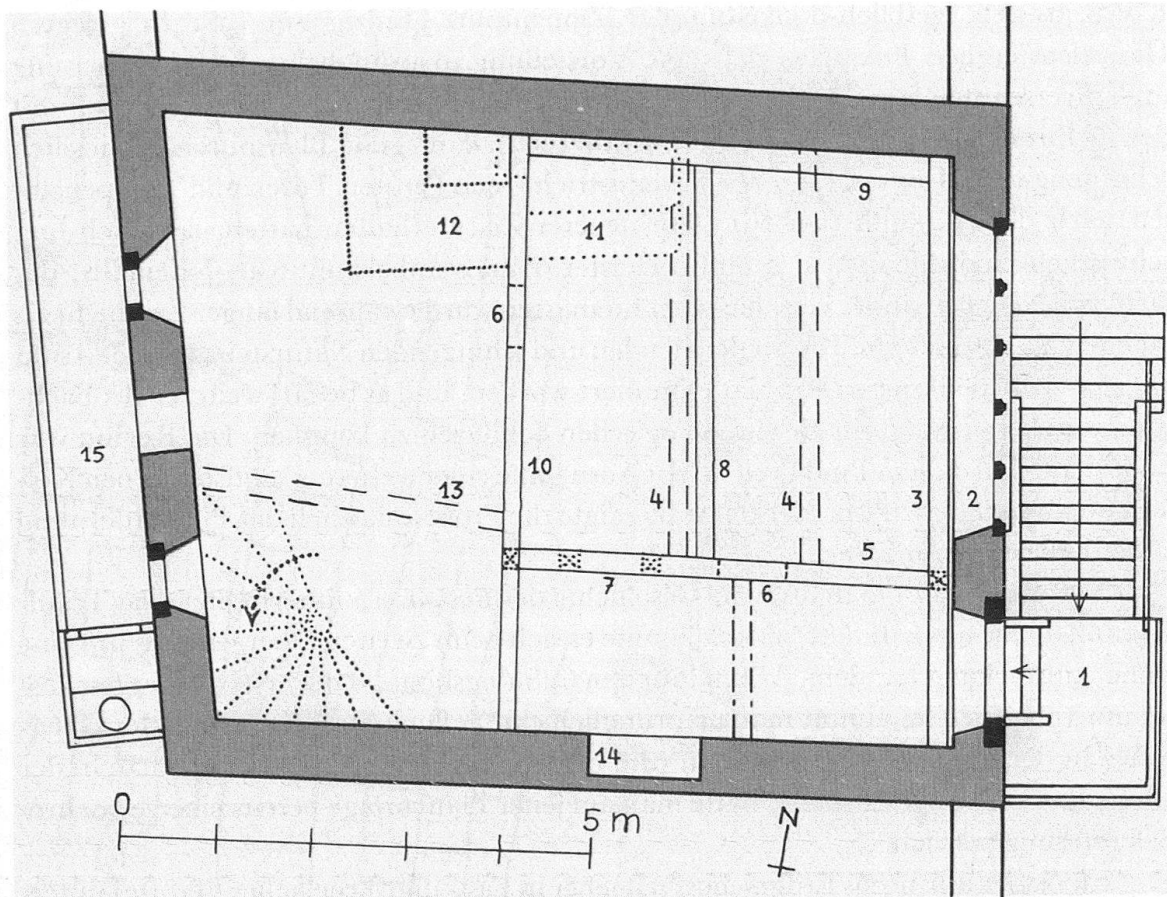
Twann, Haus Nr. 136, erstes Obergeschoss. Handskizze zur Baugeschichte und zur Rekonstruktion des spätgotischen Deckensystems. Grundlagen: Planaufnahme E.J. Propper um 1900, Aufdeckungen 1981
